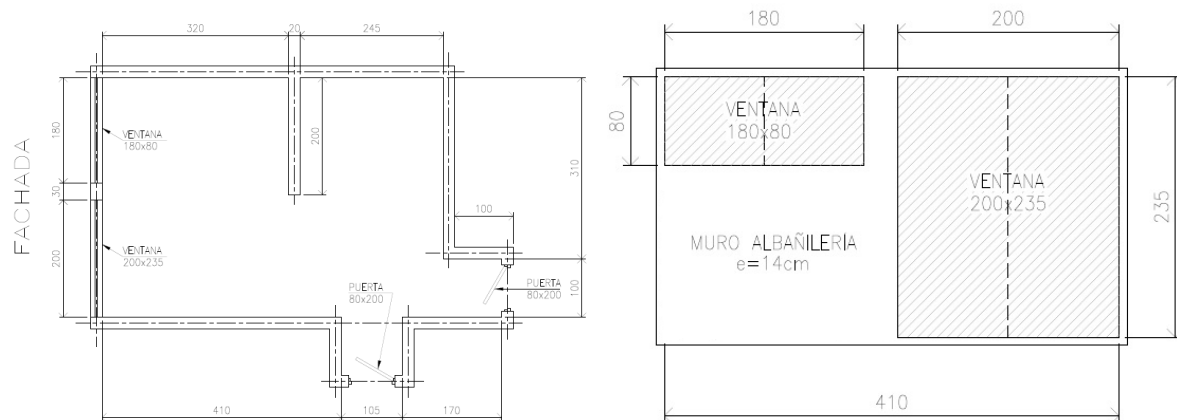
Vista en planta y elevación del recinto utilizado para el ensayo.
